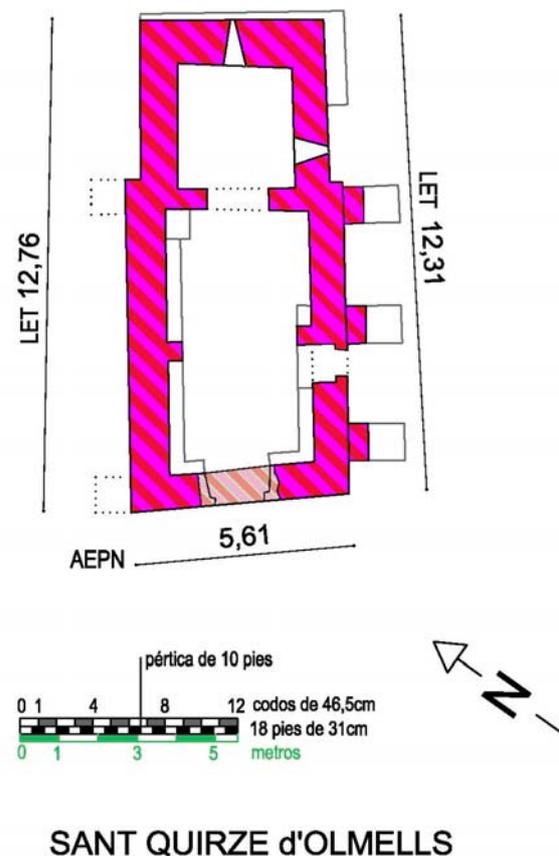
Planta crono-cromática de St. Quirze. Elaborada por autora.
